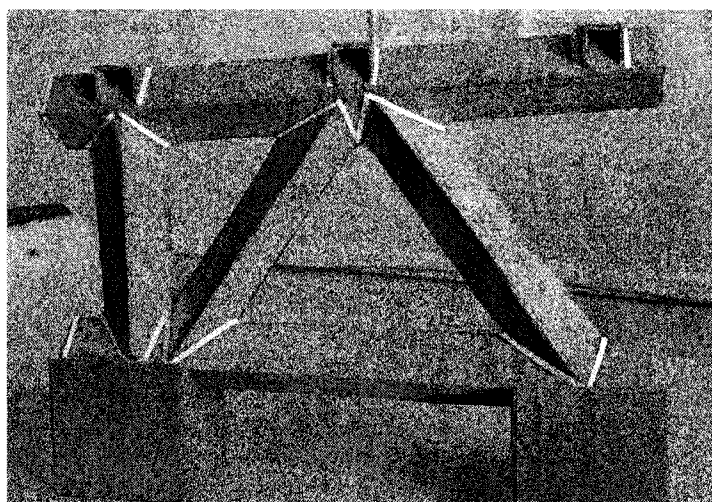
Макет фрагмента безфасоночной фермы из квадратных труб на ребро
